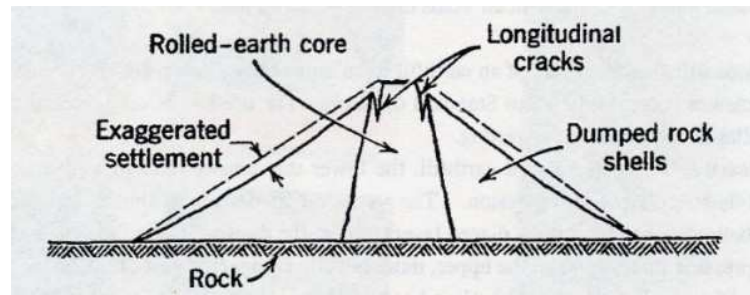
Fissurations longitudinales observées sur des barrages à noyau central, d'après [HUN03a].
